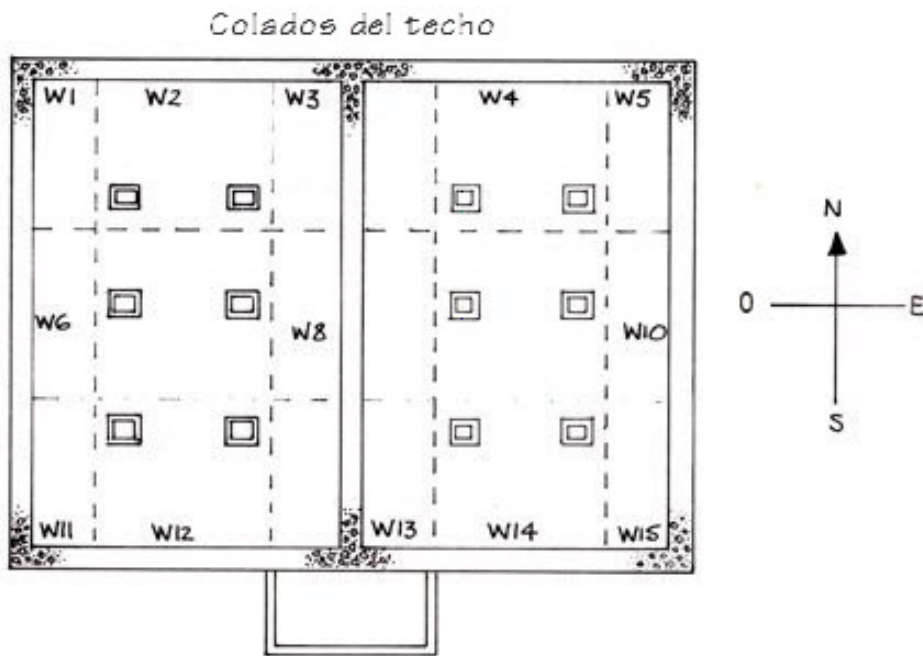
Diseño conjunto del trazado y colado del hormigón de las paredes de la presa
